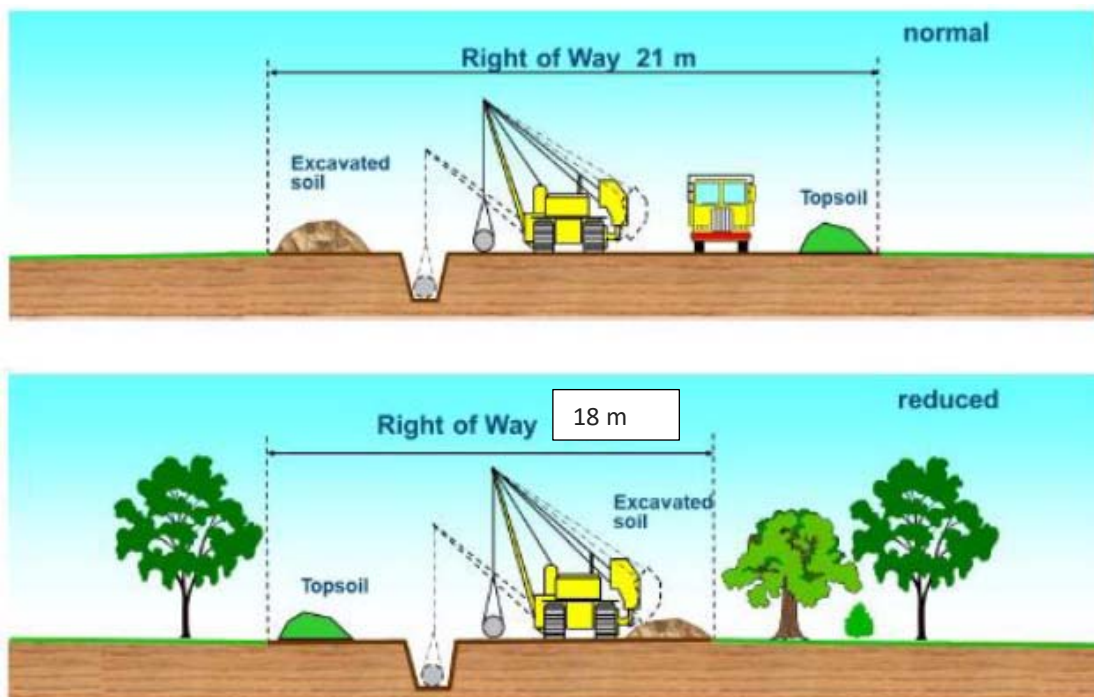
Sezione tipo dello scavo della pista di lavoro
